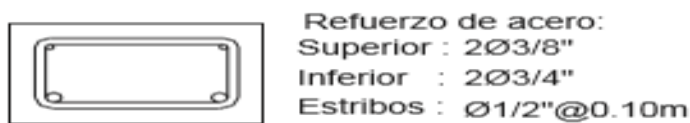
Viga de Control. Ensayo a Flexión. Fuente Proaño Tataje.
